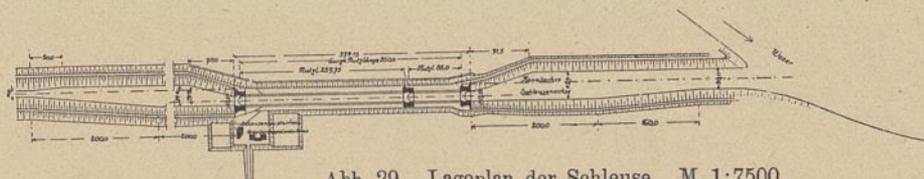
Lageplan der Schleuse. M. 1:7500.
